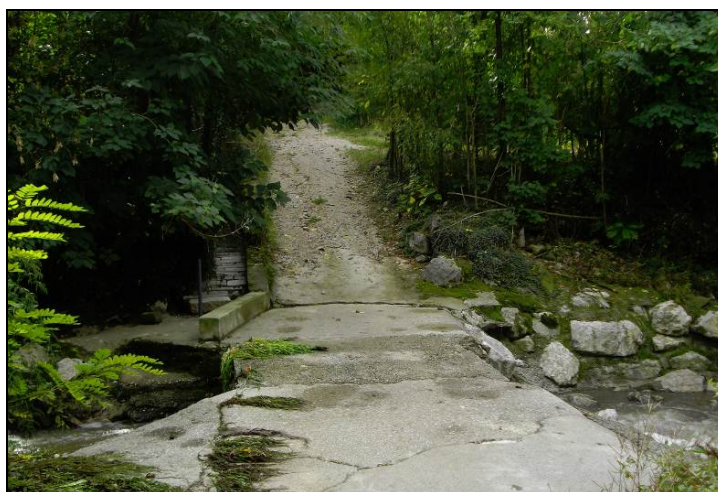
muretto di protezione spondale a valle del terrapieno di Viale Oriani. Lunghezza della protezione circa 10 metri. Particolare vedi vista frontale sotto.
